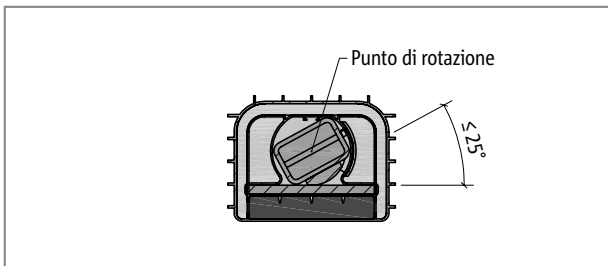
Schöck Tronsole® tipo Q, variante di montaggio inclinata dell'elemento portante
